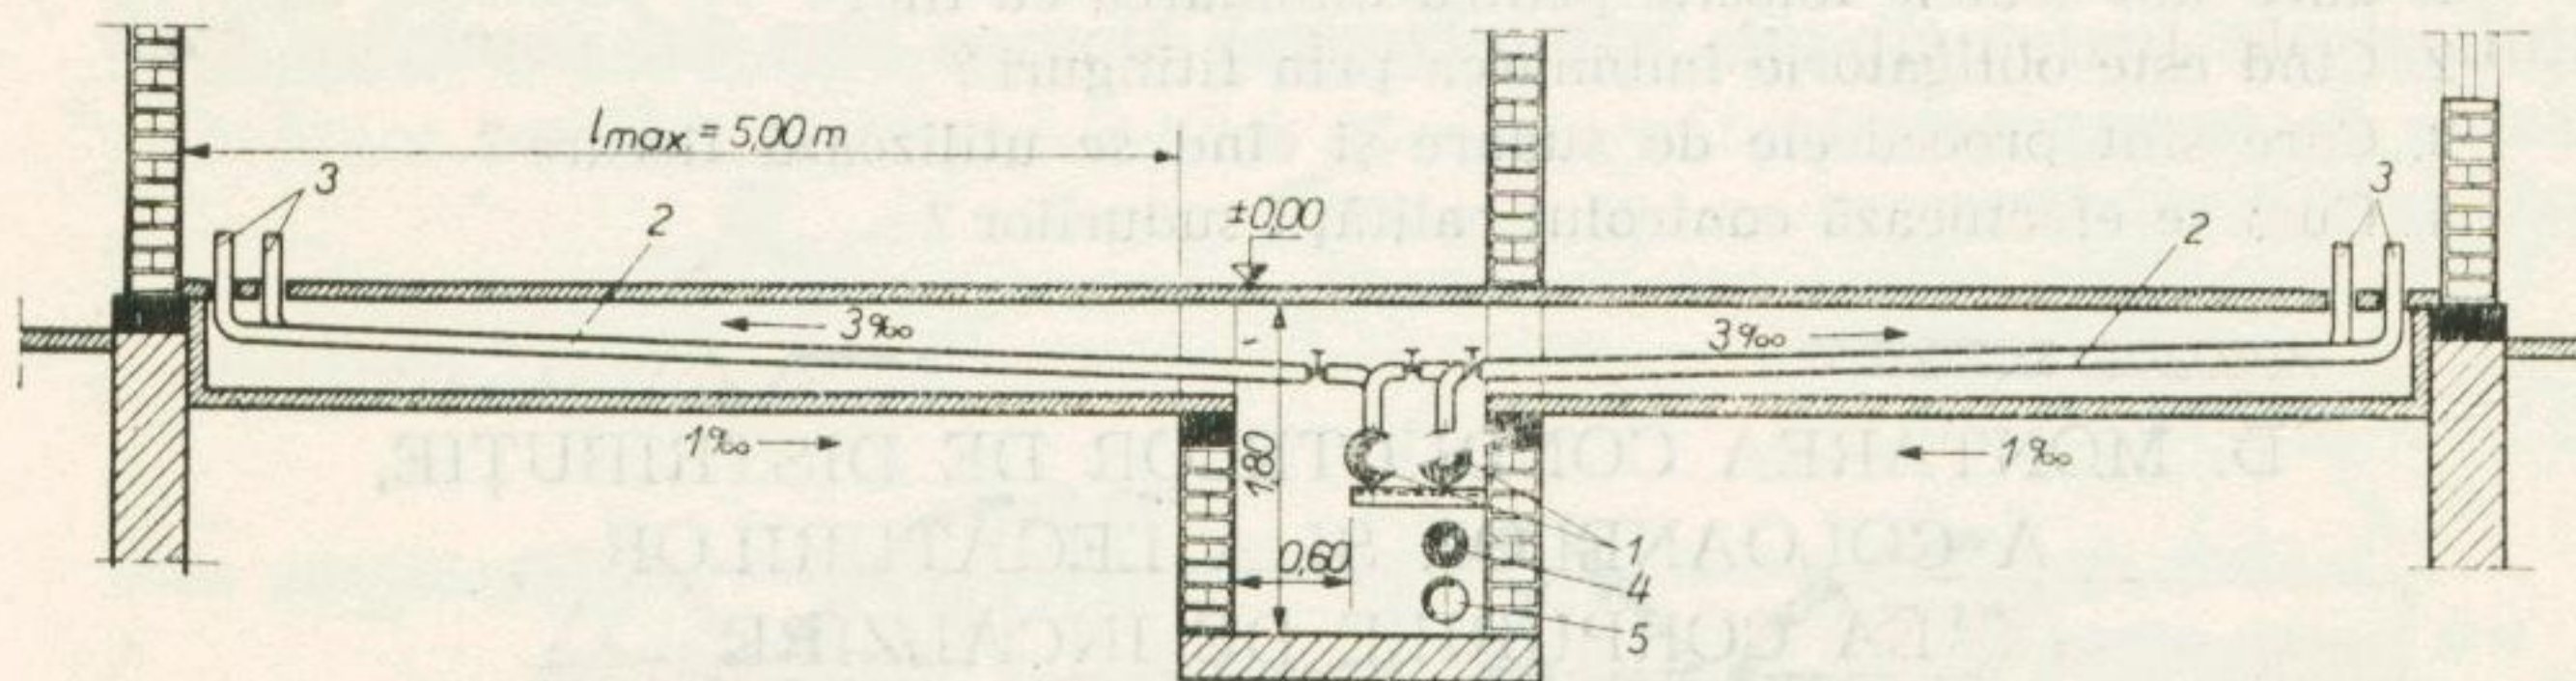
Montarea conductelor de distribuție în canal median vizitabil și canal nevizitabil sub pardoseală :
